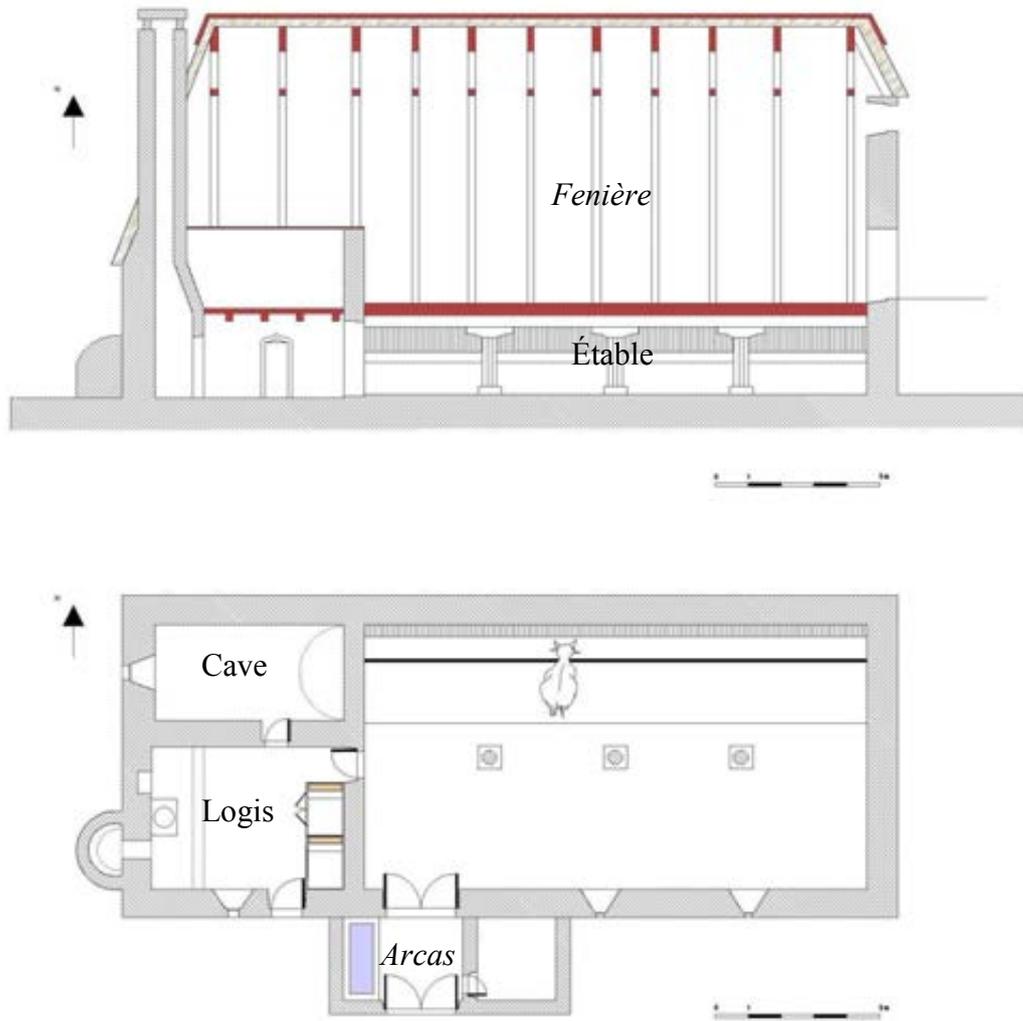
Coupe et plan schématiques d'une ferme traditionnelle
